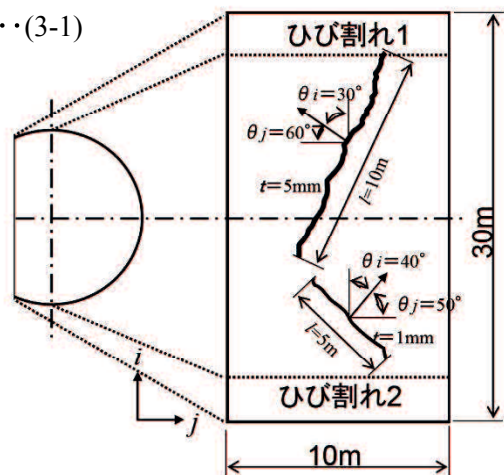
TCIの基礎式と算出例のためのひび割れ展開図¹¹⁾を加筆修正
